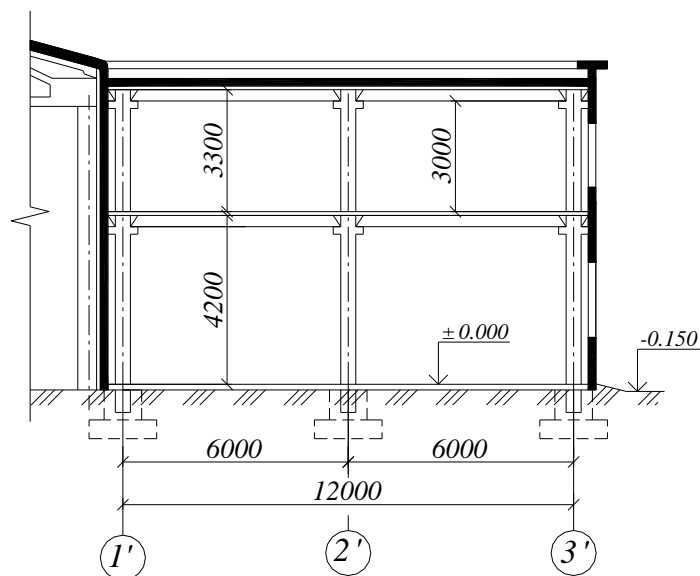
Поперечний розріз прибудови до виробничої будівлі
